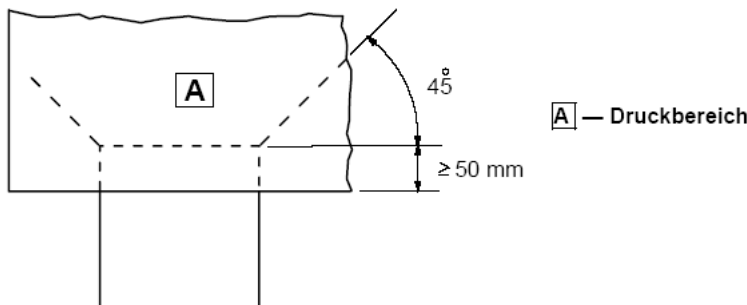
Verbesserung der Verankerung im Druckbereich
